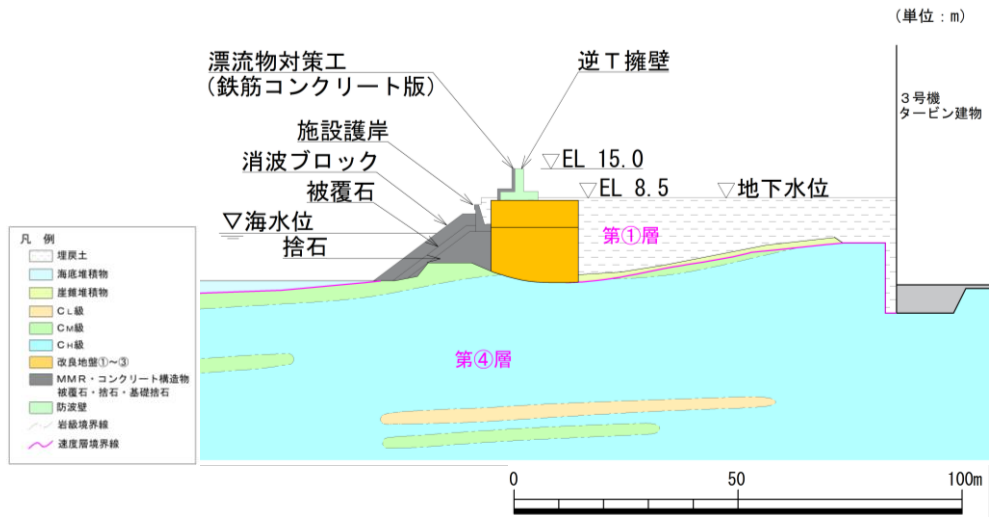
防波壁（逆 T 擁壁）の横断面図（⑤-⑤断面）
